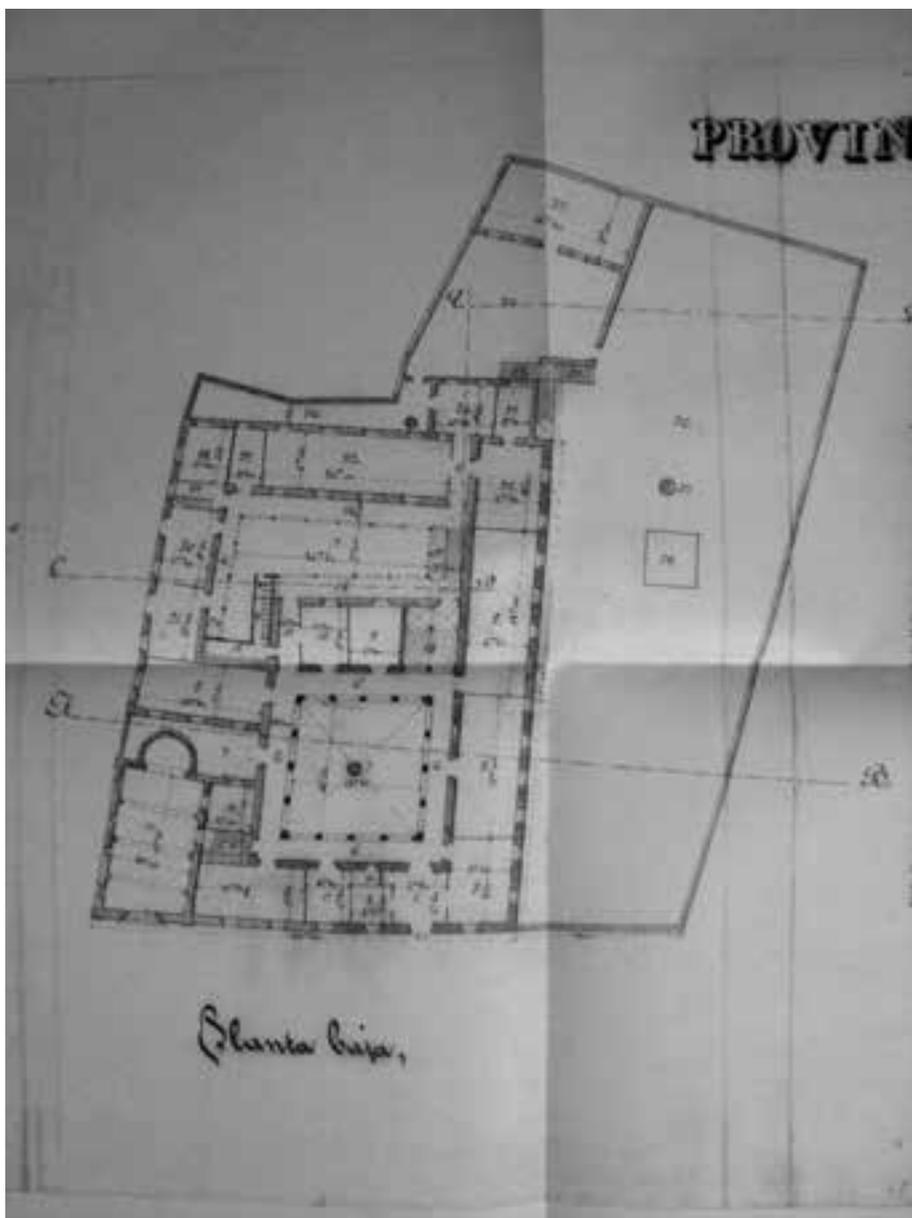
Plano de la planta baja del Colegio de los Escolapios (1864). Arquitecto Pablo Cuesta.
